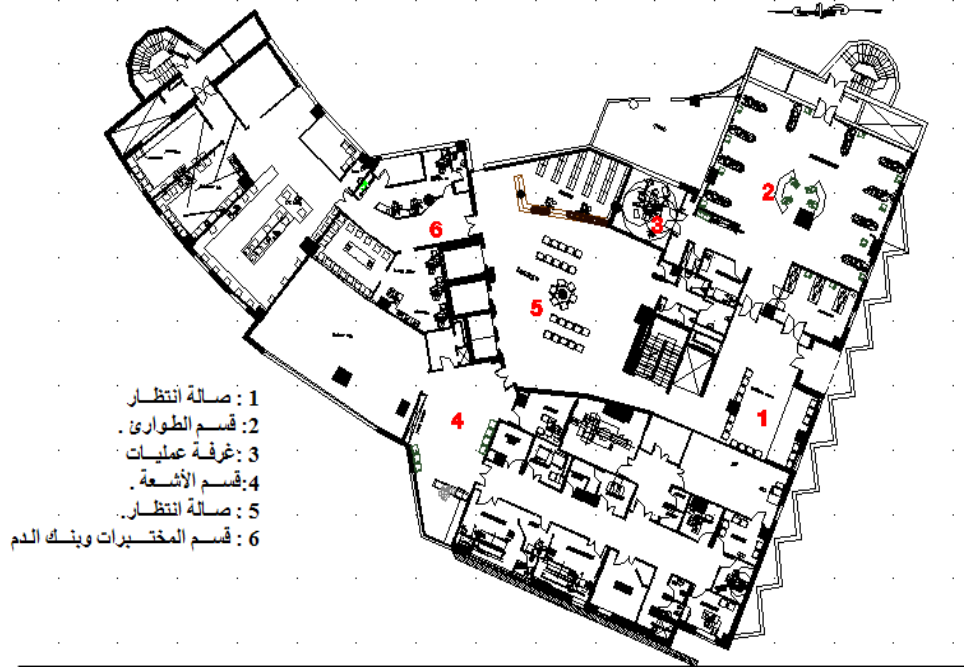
مسقط الطابق الأول للمستشفى .
